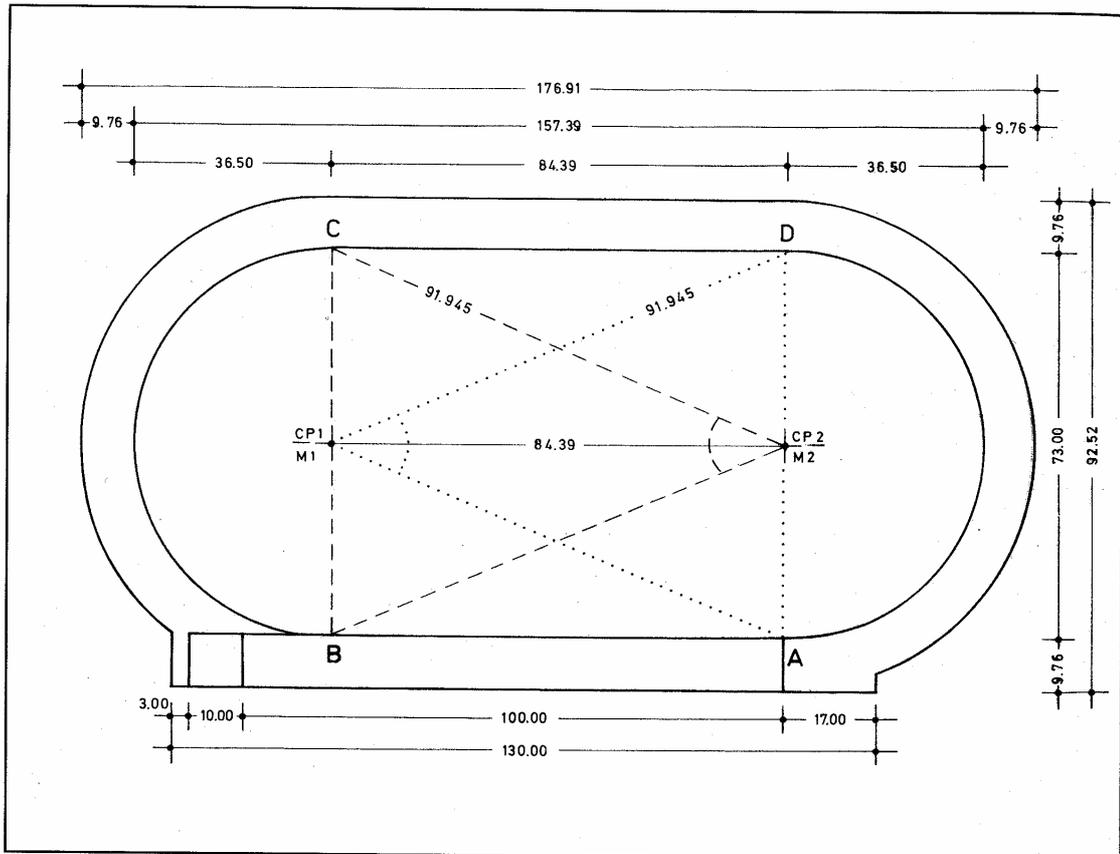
Plano y dimensiones de trazado de la Pista Estándar de 400 m.
